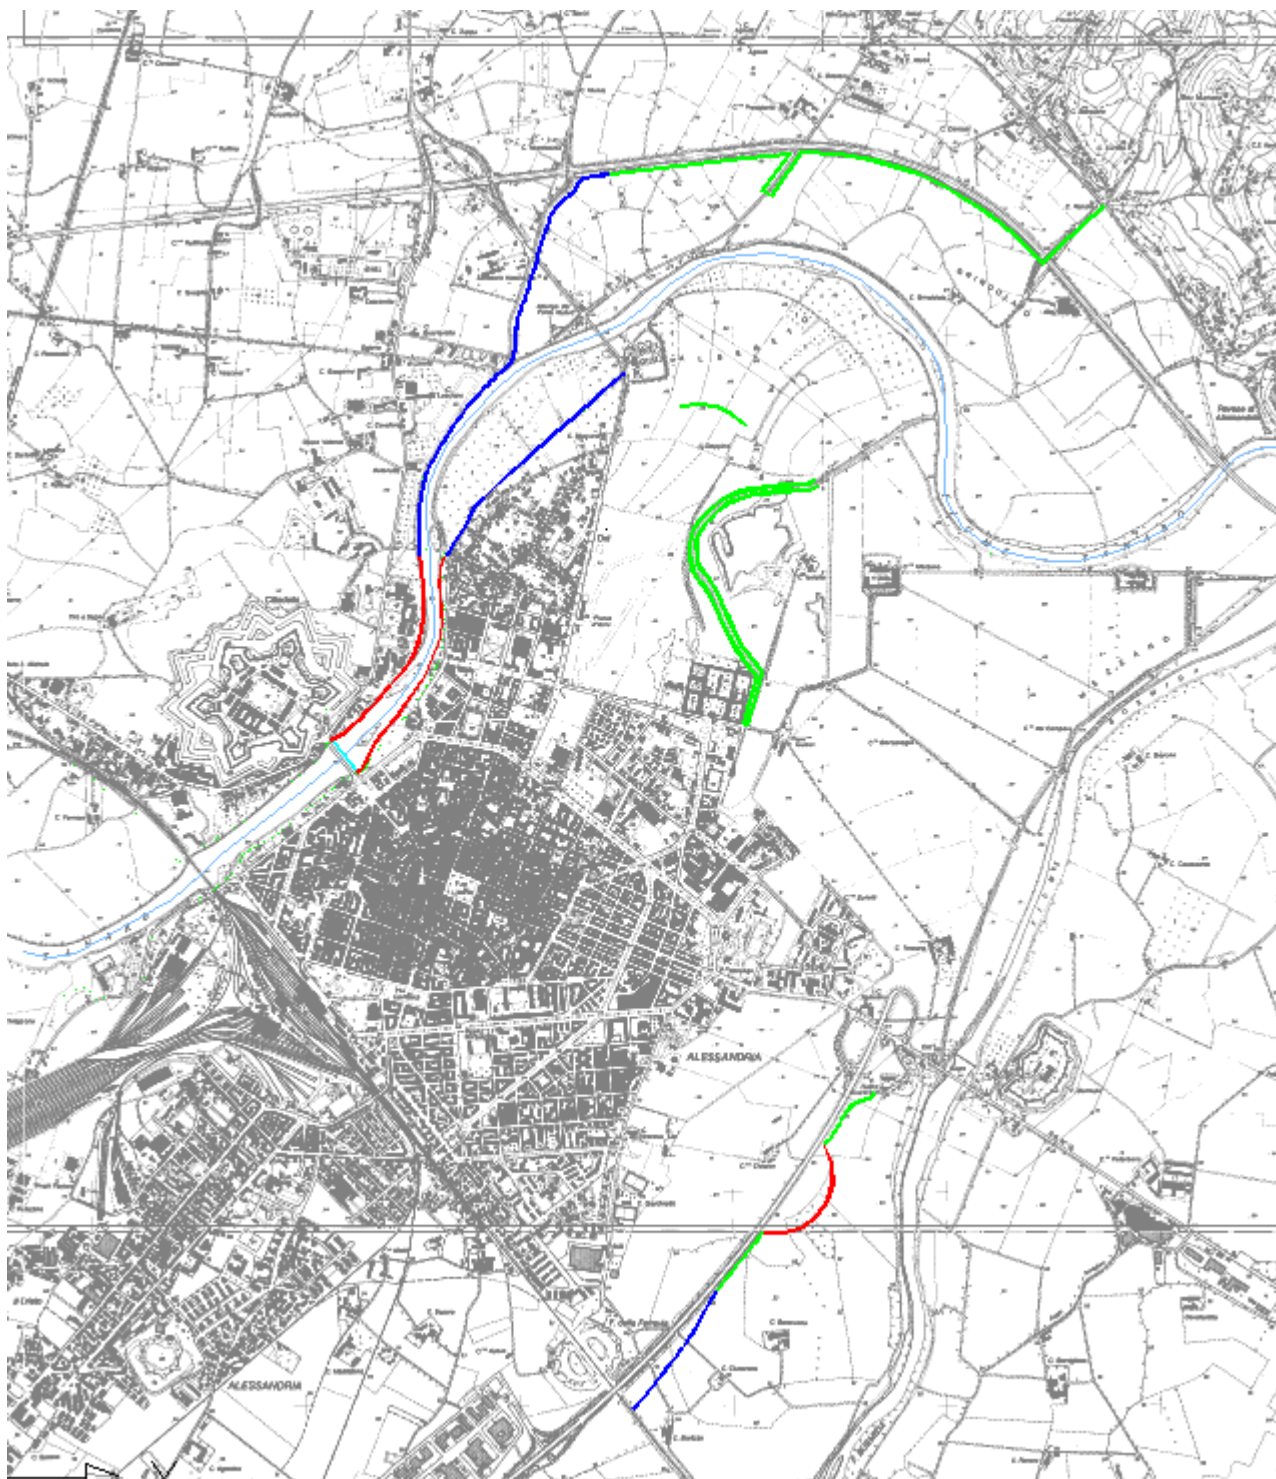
Zone interessate dall'innalzamento arginale previsto in progetto
